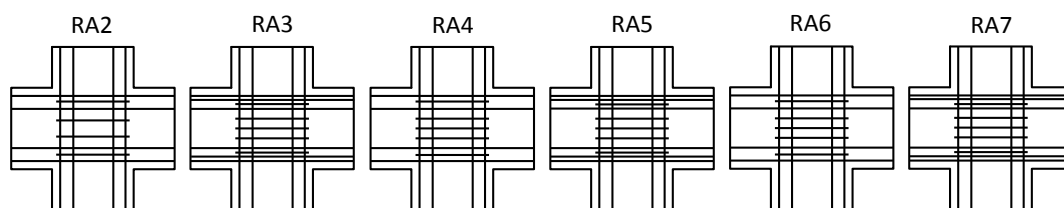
Representação esquemática das ligações viga-pilar interiores ensaiadas por Roeser [2002].
